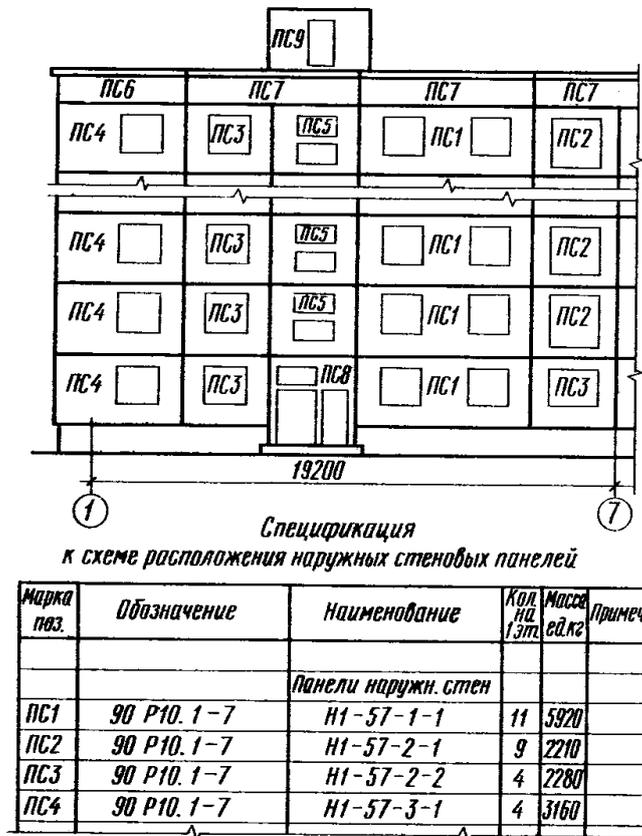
Схема расположения наружных стеновых панелей жилого дома
